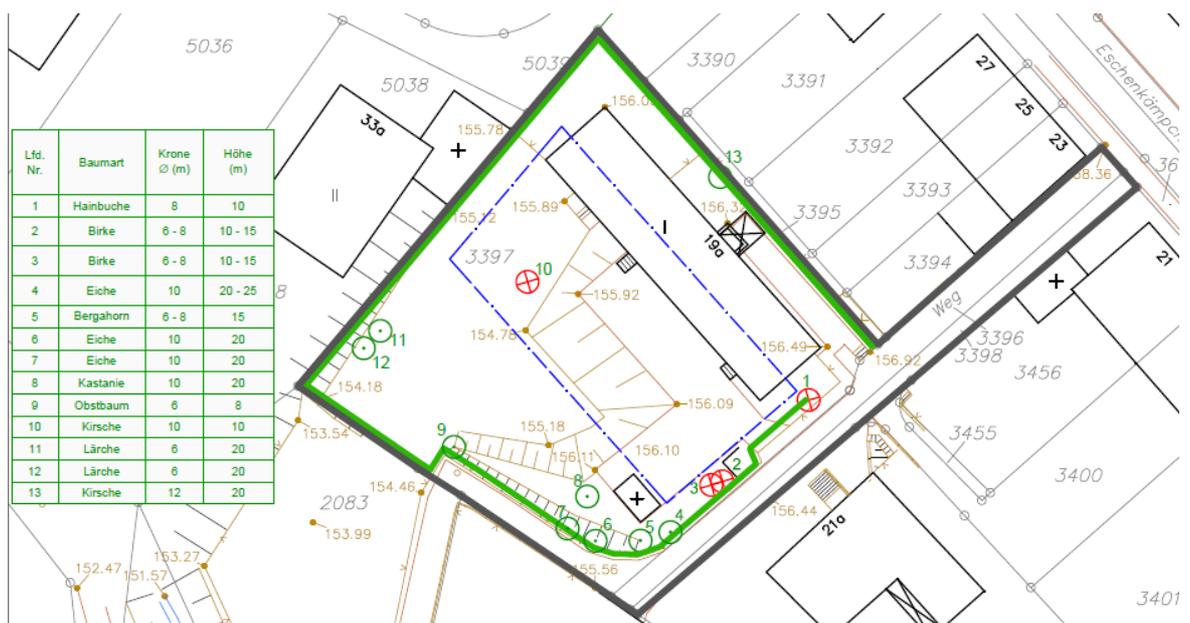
Baumbestand und überbaubare Grundstücksfläche (in blau), Kennzeichnung der zu erhaltenden Bäume in grün, die zu fällenden Bäume in rot, ohne Maßstab
